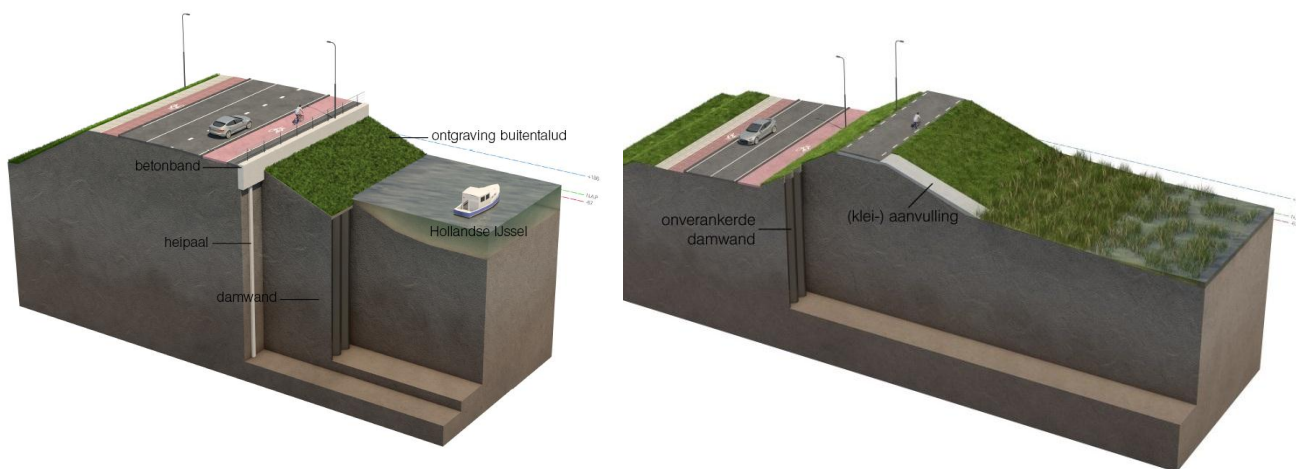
Alternatief 2: Damwand buitenkruinlijn zonder wegverhoging
